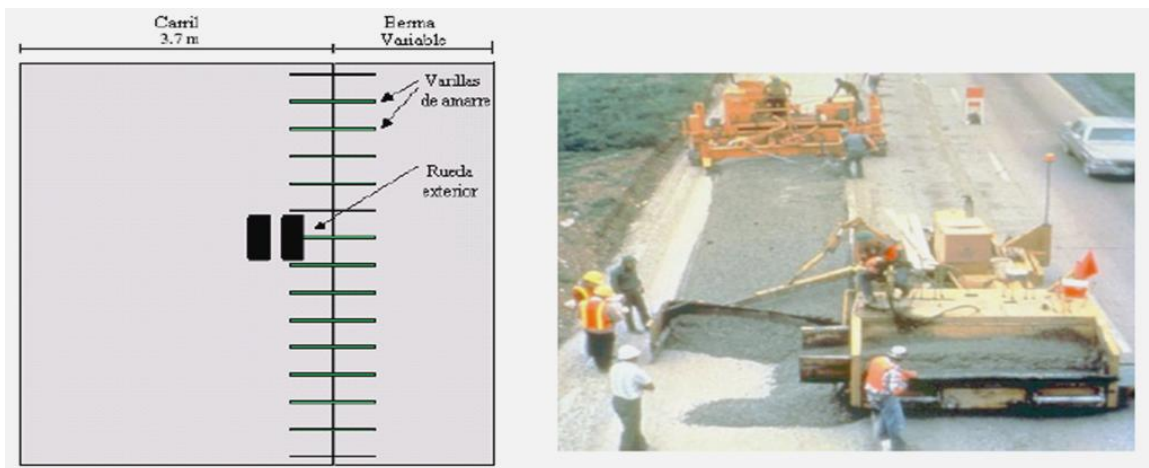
Transferencia de cargas entre losas (Existencia o no de pasadores en las juntas transversales) (Fuente: Diseño de pavimentos rígidos para calles y carreteras “Ing. Fernando Sánchez Sabogal”)
